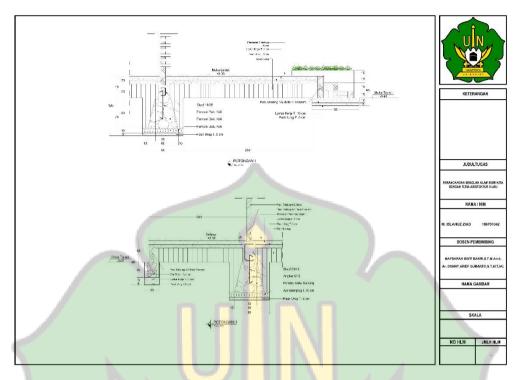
36 Denah pondasi cyclop Sumber : Dokumen Pribadi
